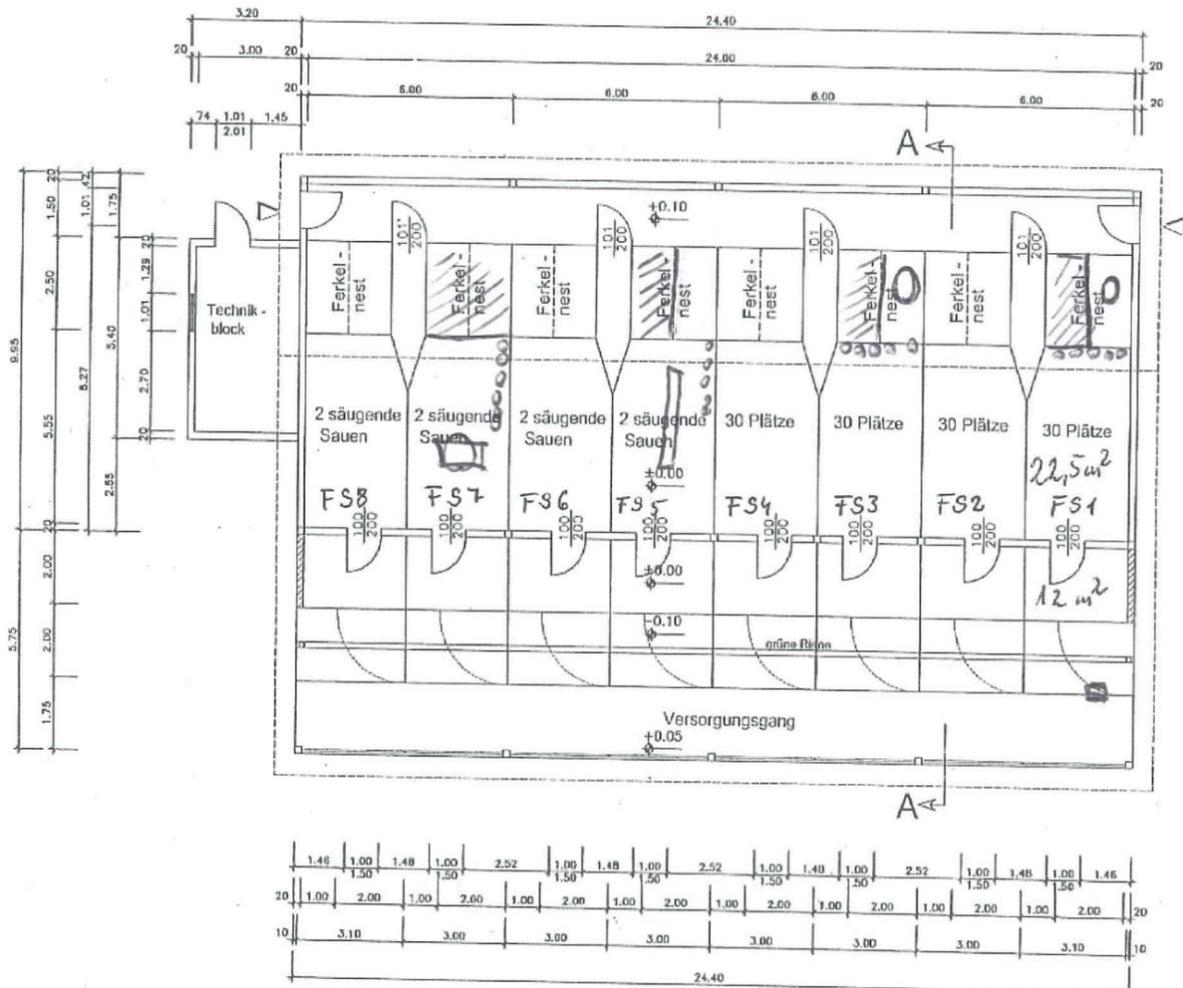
Stallgrundriss der Gruppensäugebucht im Betrieb E
